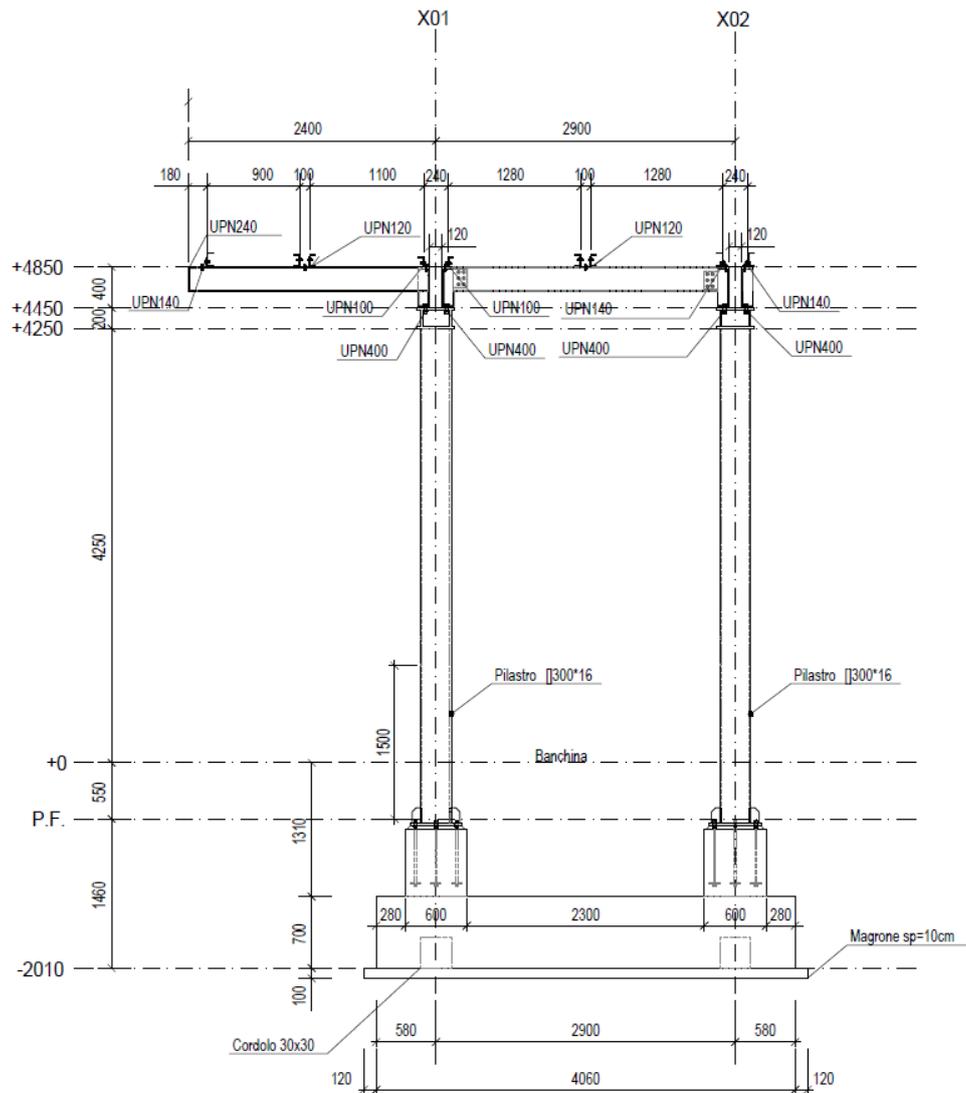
Pensiline – Sezione trasversale della pensilina a singola falda – Pensilina Sud
